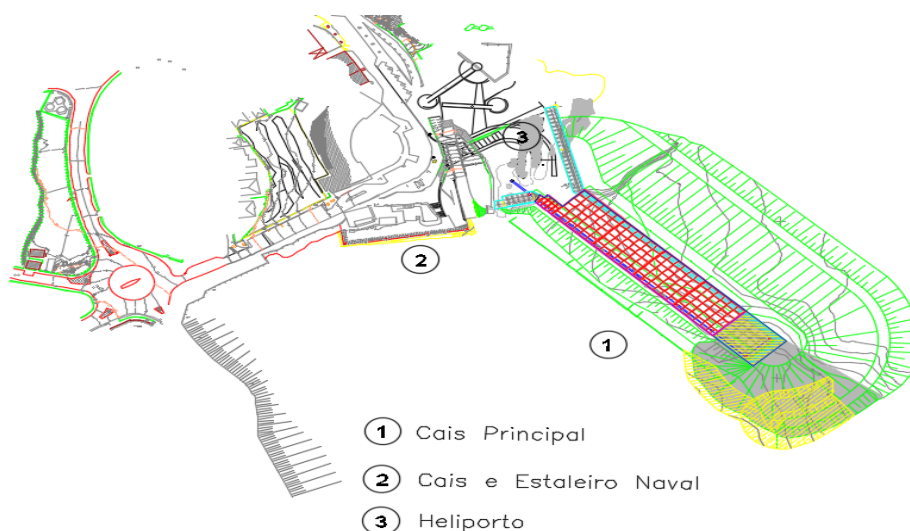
Planta do porto do Porto Moniz (APRAM, 2018).
